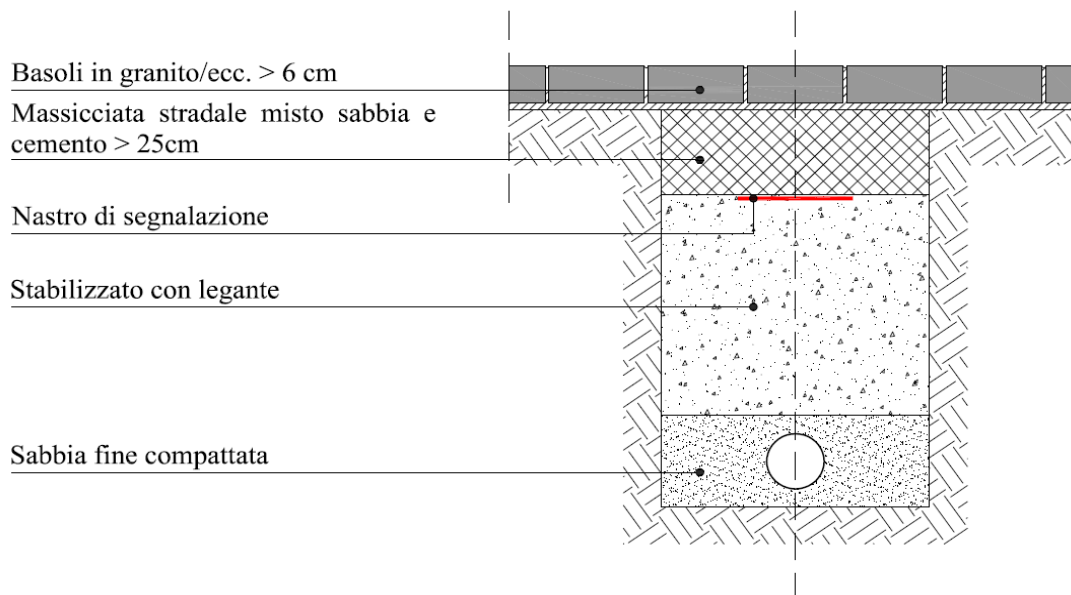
Fig. B – Sezione tipo scavo/ripristino tradizionale su pavimentazioni lastronate
